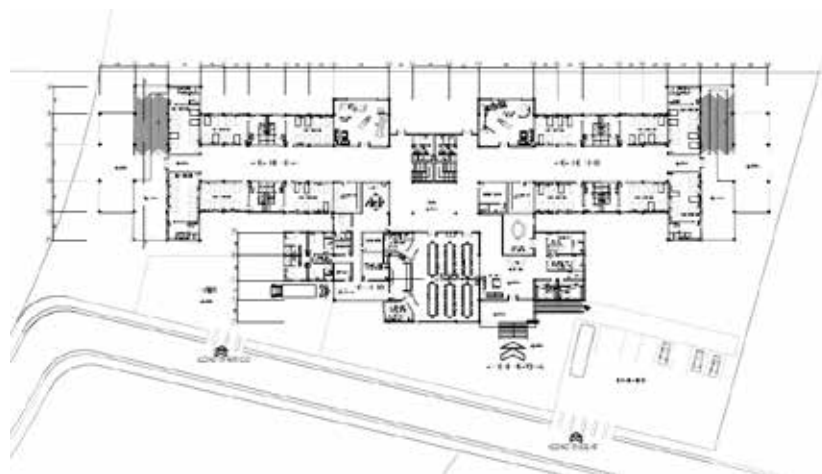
Imagen de Planta baja conjunto de la Casa Hogar Permanente.
